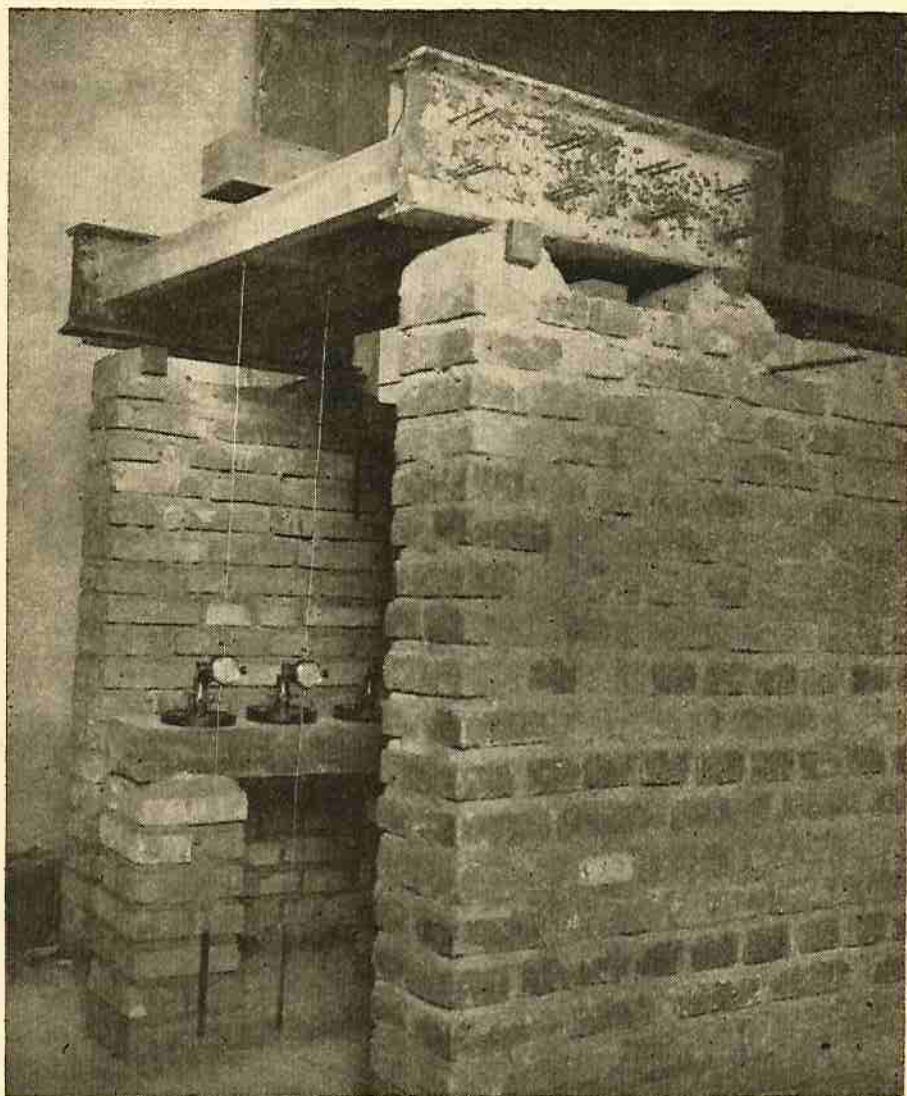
Detalhe do ensaio de grelha de concreto armado, realizado no I.P.T.
